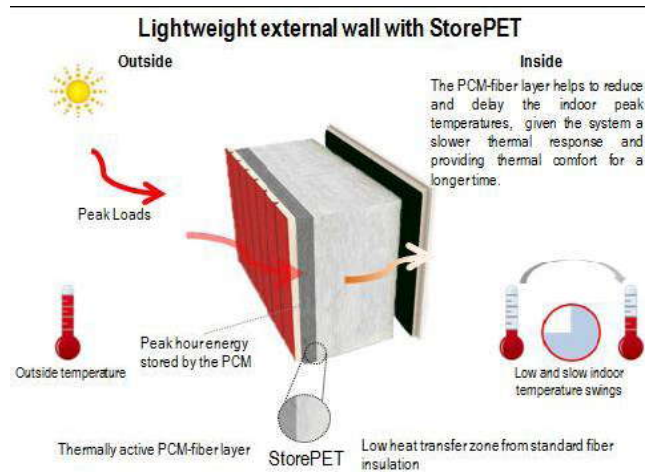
Spoljni zid lake konstrukcije sa StorePET izolacijom
